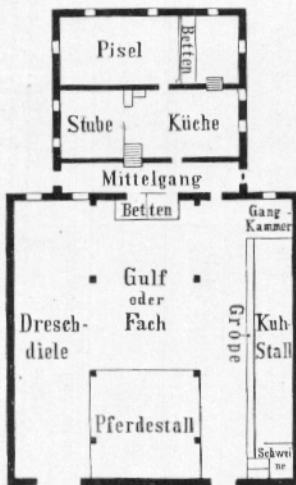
Grundriss eines ostfriesischen Hauses.
